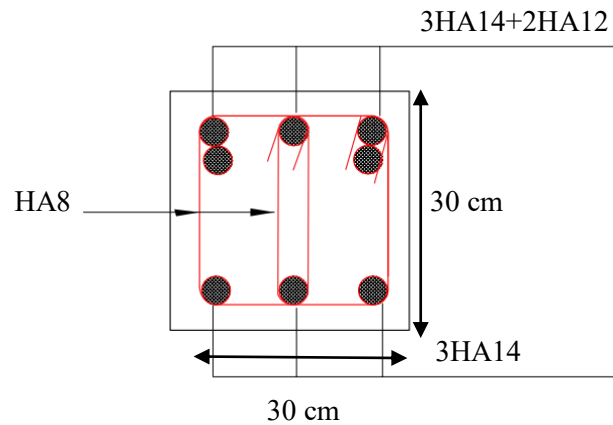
Ferrailage des poutres secondaires en appuis 30x30
